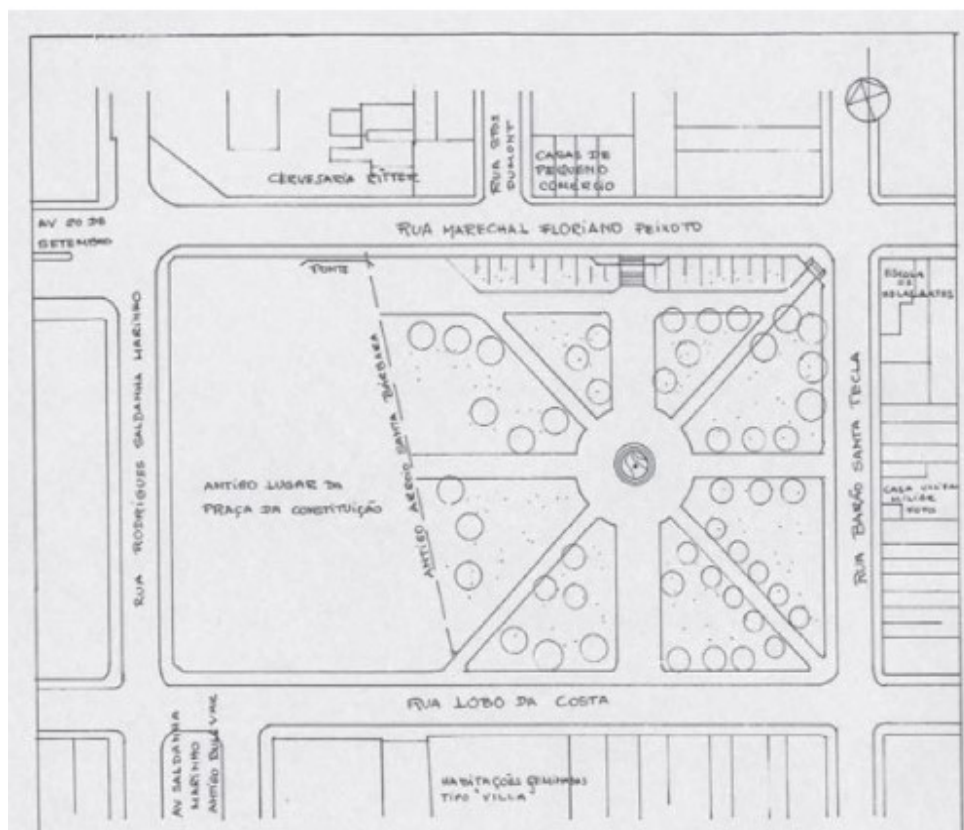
Planta baixa da Praça Cypriano Rodrigues Barcellos Fonte: MATTOS, 2007.
